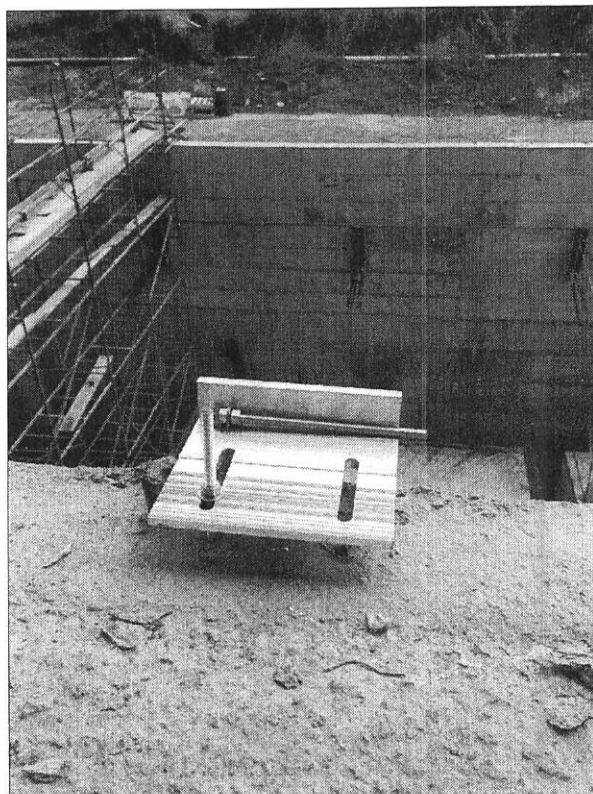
Parafuso de ancoragem sem fixação na estrutura de concreto.
